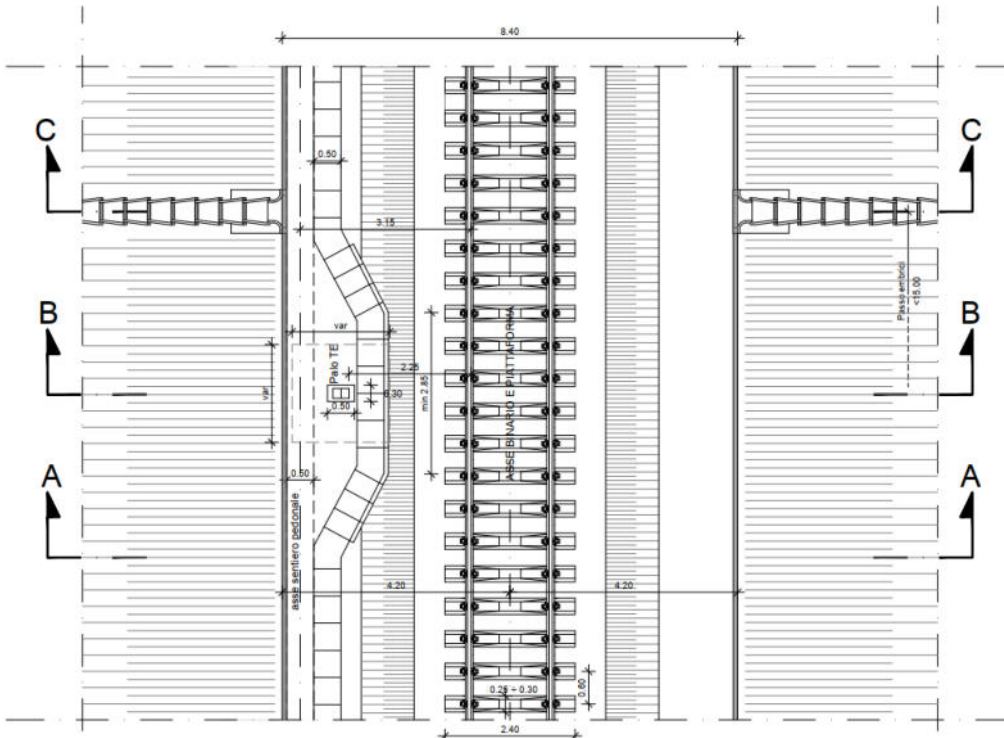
Stralcio planimetrico con sezione tipo ferroviaria in rilevato a singolo binario in rettilo
